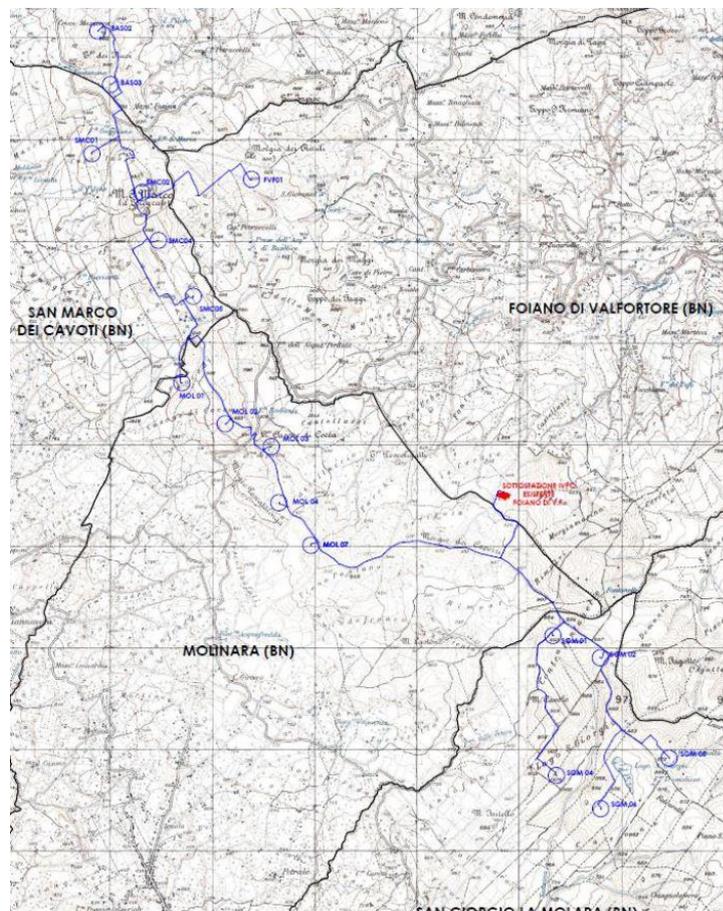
Planimetria del nuovo impianto su cartografia IGM.
